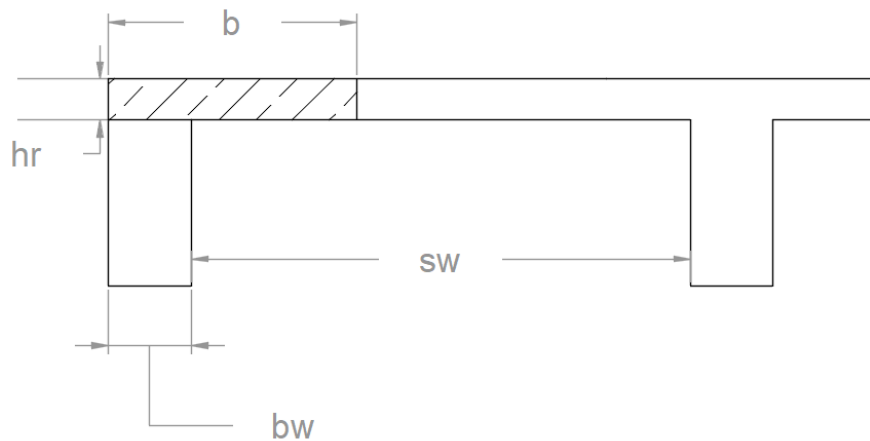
Ancho efectivo de contribución de la losa, viga exterior
